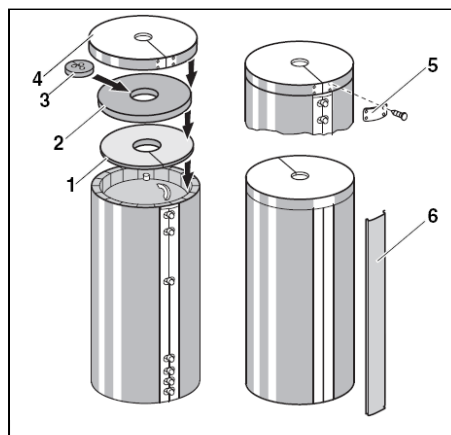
Монтаж теплоизоляции (принципиальная схема)
